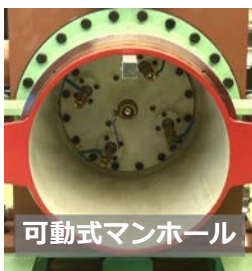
可動式マンホール接続前状況 写真-3 可動式マンホール接続中状況（水中） 写真-4 可動式マンホール接続後状況
